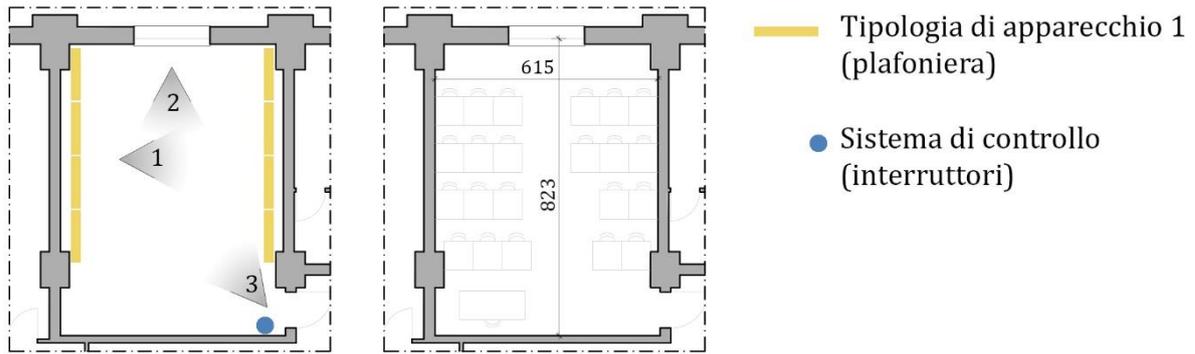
Piante in scala 1:200 con posizione degli apparecchi e degli interruttori, con ottico delle foto, posizione dei banchi e quote dell’aula nord-est del piano terra.
